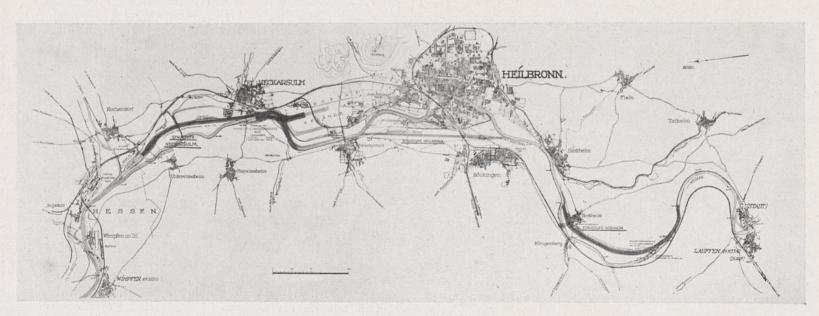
Lageplan der Staustufen Neckarsulm, Heilbronn und Horkheim.
